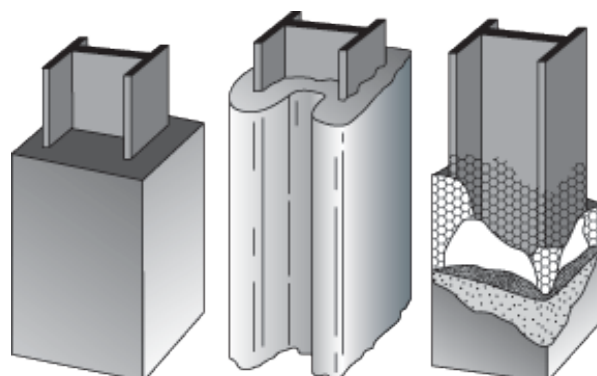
Pórtico mixto: Acero y Hormigón (detalle de columna)
